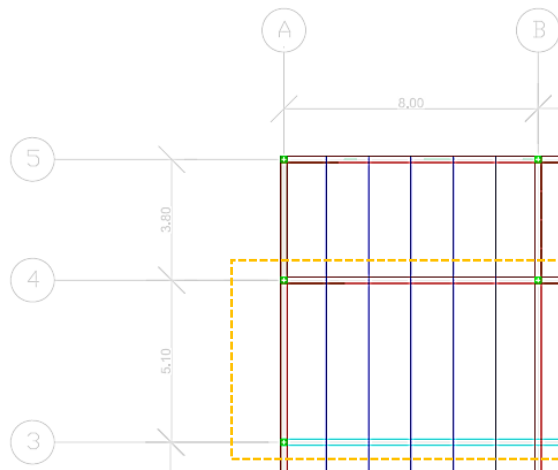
Disposición de viguetas en planta AB -43 .
